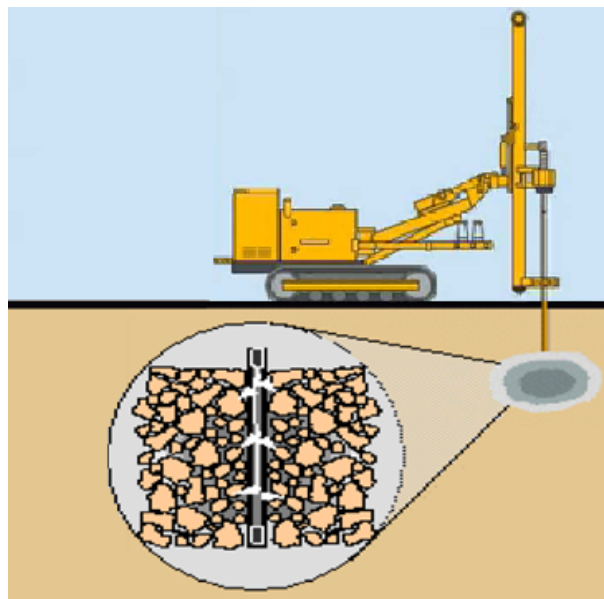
Injection des sols en vue de l'excavation d'un tunnel
